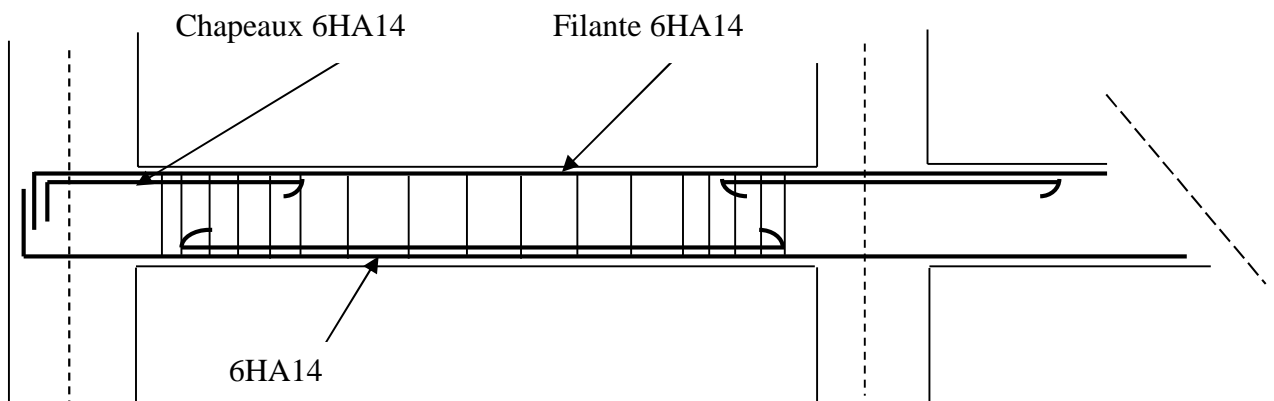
schémas de ferrailage des poutres secondaires (sous sol ,RDC ,étage service,1étage)
